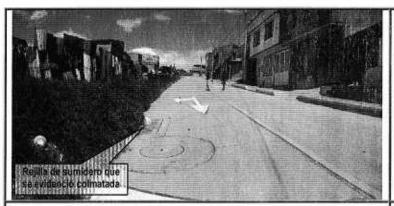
Vista de la Transversal 74A entre la Diagonal 62H Bis Sur y la Calle 63 Sur.
